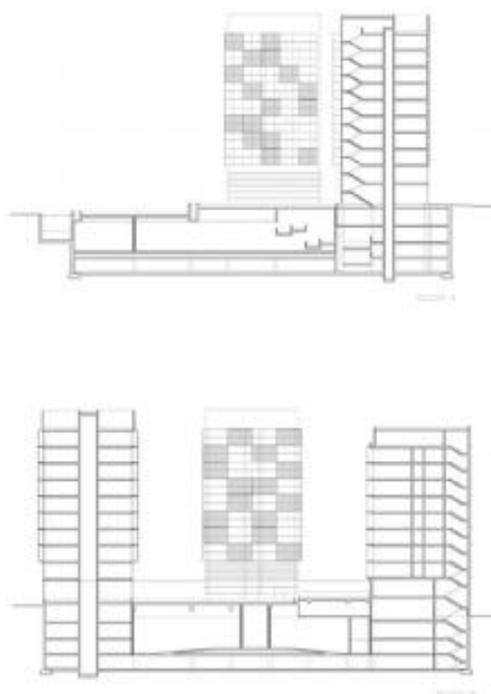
Proyecto Illa Fleming, Planta y Alçades.
